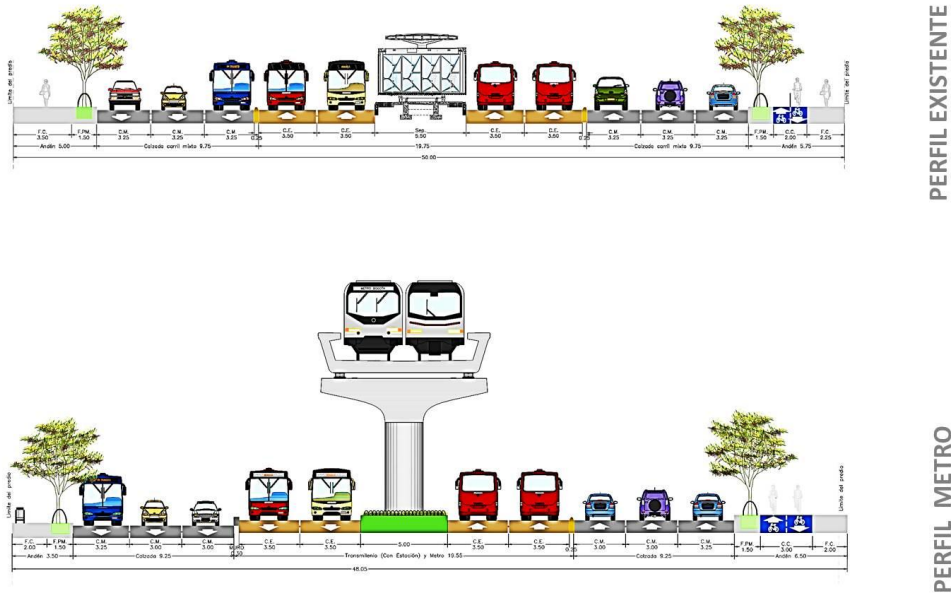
Sección transversal a nivel entre estaciones BRT en la Avenida Norte Quito Sur (NQS) entre la Avenida 1ra de Mayo y la Avenida Octava Sur. Fuente: Elaboración Propia 2017 (Anexo 3.3)
